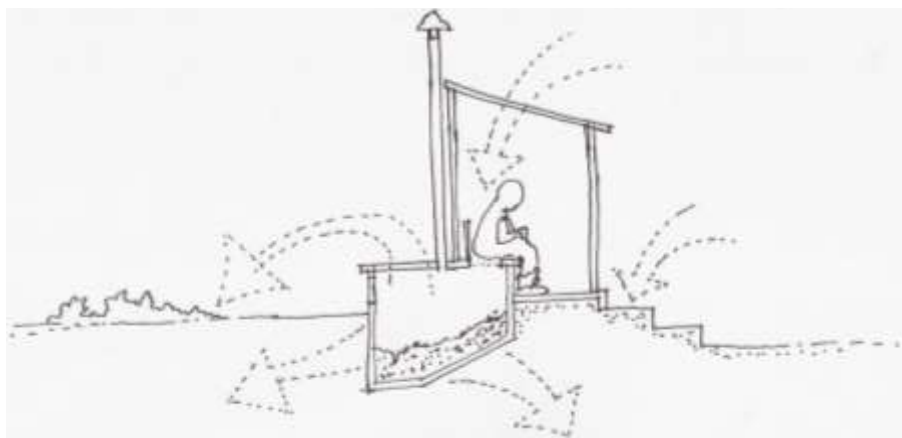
Vista posterior de banheiro seco com duas câmaras e ventilação aérea
